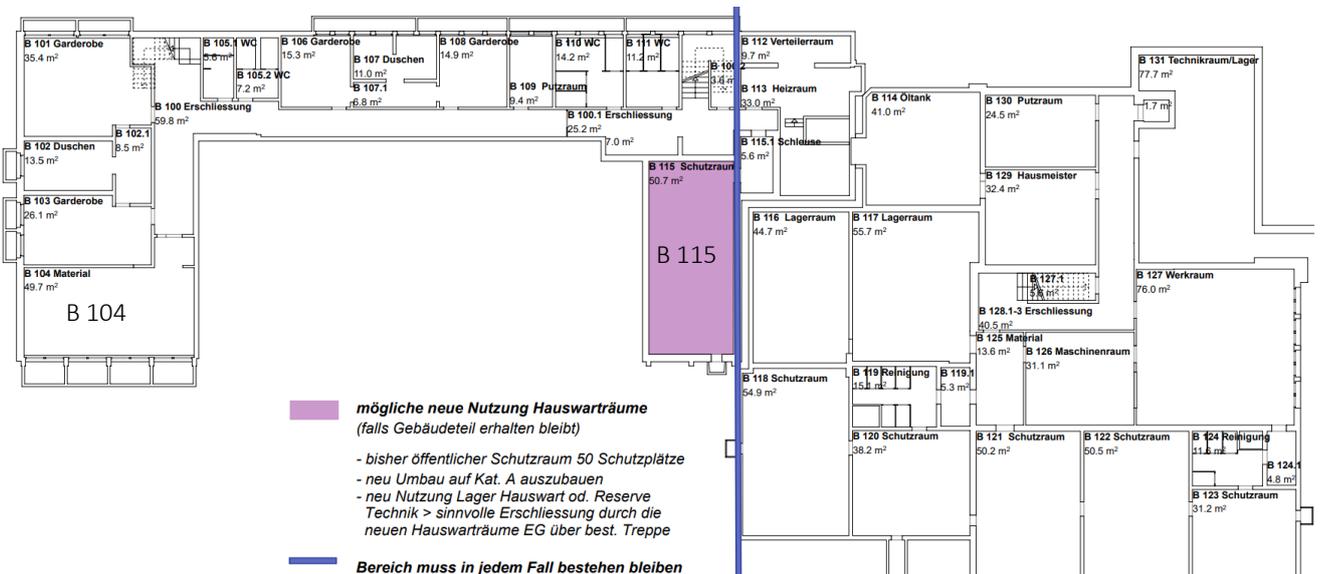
Skizze zur Umnutzung der freierwerdenden Flächen im Untergeschoss, Schnittstelle blau markiert
